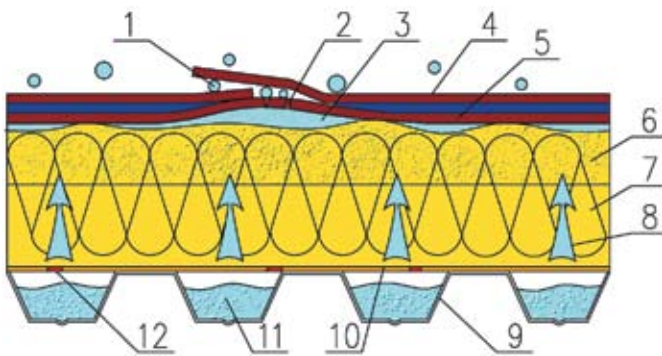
1 – атмосферная влага; 2 – вздутие кровли; 3 – паровоздушный карман; 4 – верхний слой гидроизоляционного ковра; 5 – нижний слой гидроизоляционного ковра; 6 – верхний слой утеплителя; 7 – нижний слой утеплителя; 8 – диффузионное движение влаги; 9 – несущий профнастил; 10 – пароизоляция; 11 – снег и лед в пазах профнастила; 12 – повреждения пароизоляции
